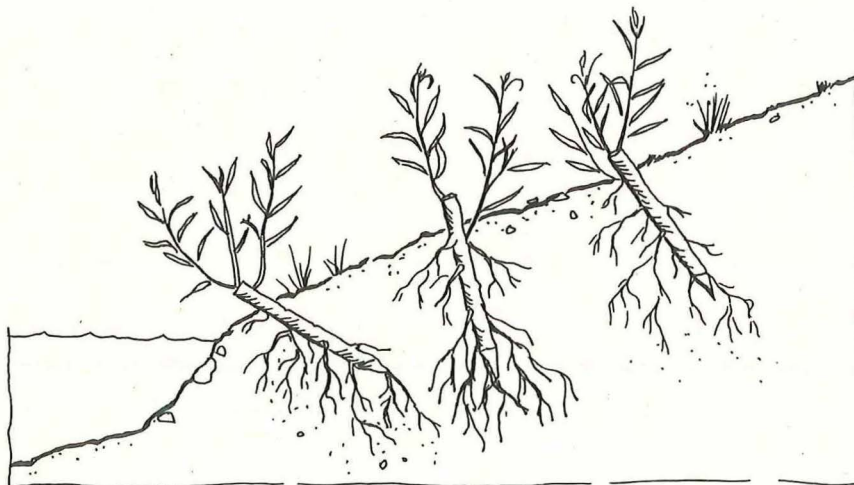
Einbau von Steckhölzern zur Ufersicherung, Querschnitt – unterschiedliche Bewurzelung je nach Einbauwinkel zur Böschungsoberfläche (Quelle: Stowasser)
